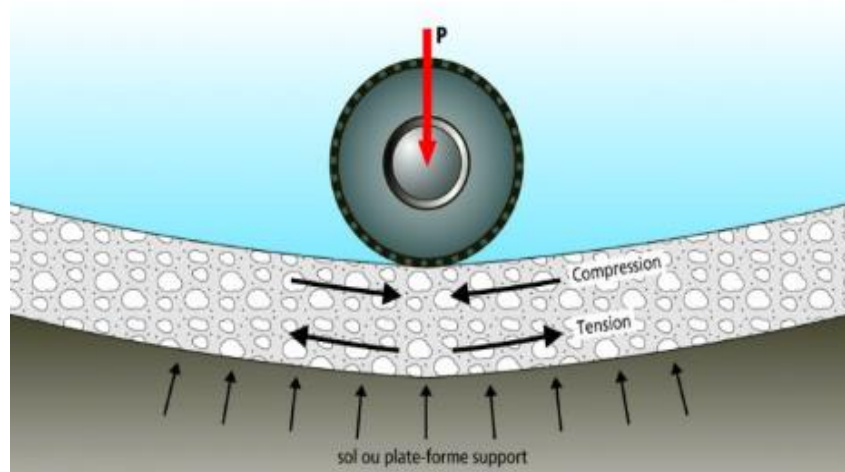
Le comportement flexible de chaussée souple [3]
